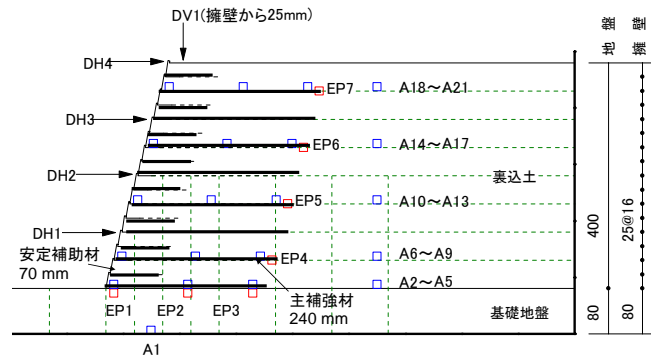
補強材配置の影響に関する模型実験の概要 (Case5-2 の場合、単位: mm)
